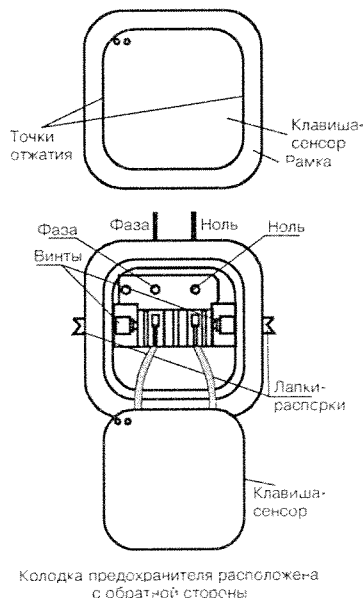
Внешний вид и устройство выключателя «Сапфир»
